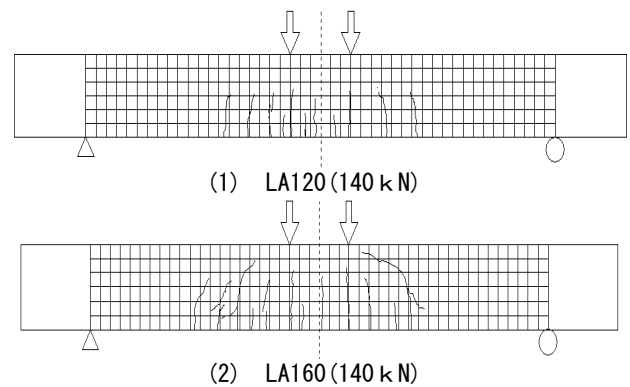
斜めひび割れ発生直前のひび割れ進展状況 LA シリーズ (載荷時の荷重)
